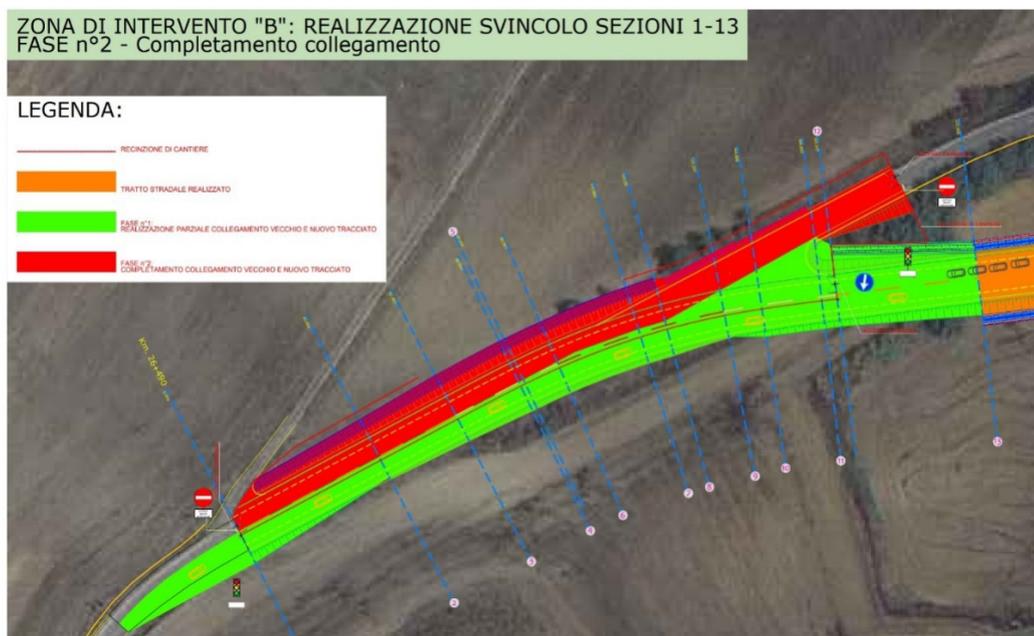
Stralcio 1 da Tavola 22 del progetto (fasi lavorative)
